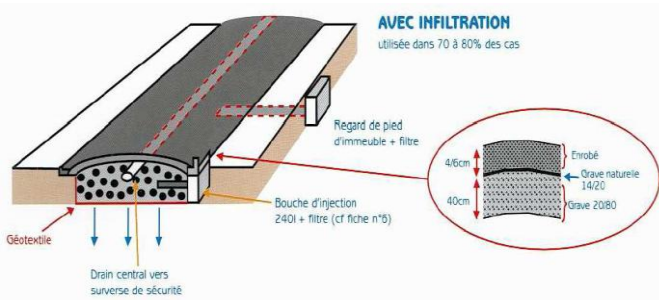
Principes du dispositif des chaussées à structure réservoir avec infiltration
